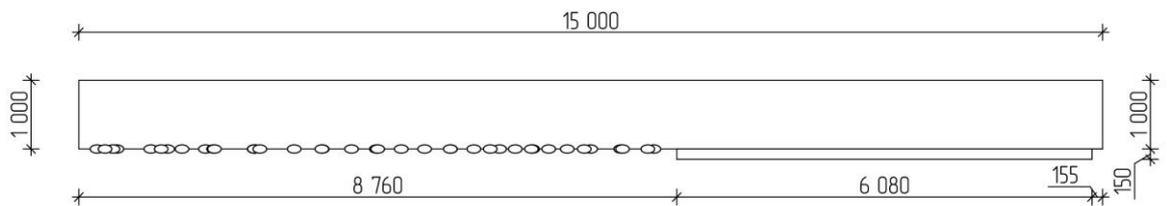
Чертеж скалодрома. Вид сверху
